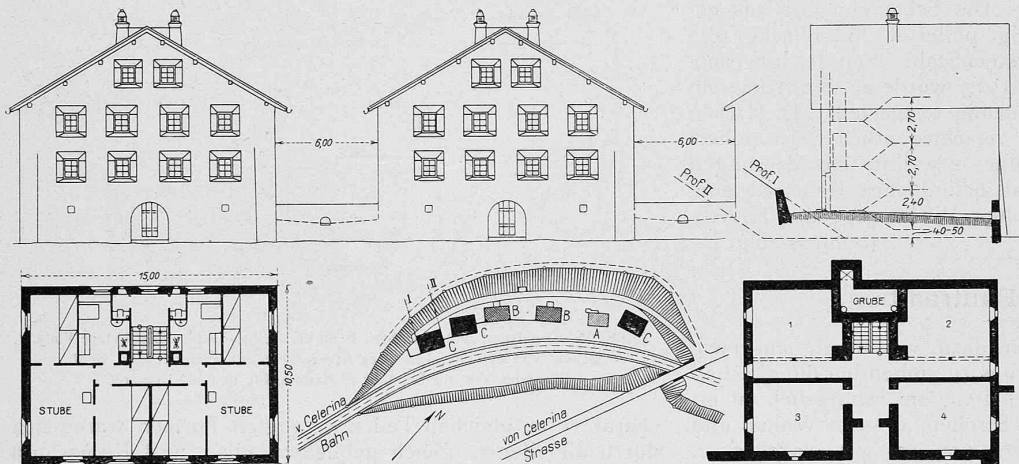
Lageplan 1:4000, Abb. 9 bis 11 Grundrisse, Fassaden und Profil 1:400 der Häusergruppe Arieffa (Samaden) der Rh. B.
